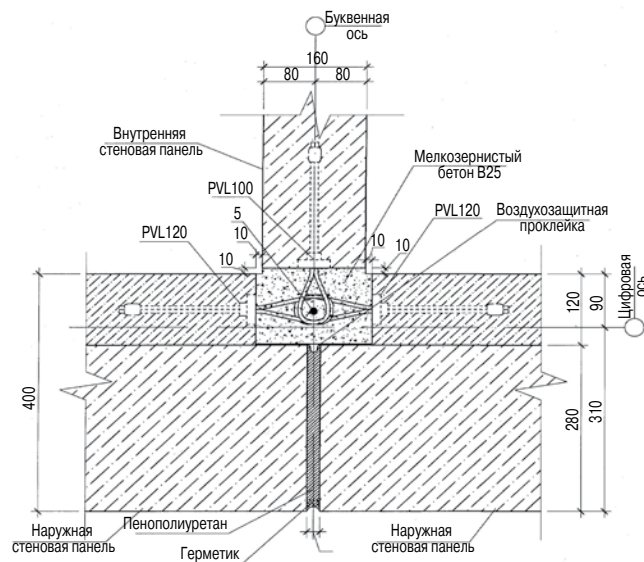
Рядовой вертикальный стык наружной и внутренней стеновых панелей
